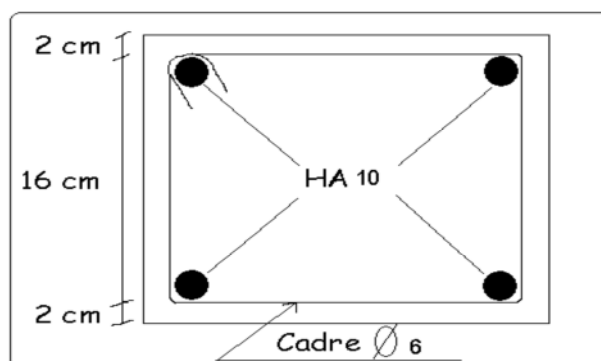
Schéma de ferrailage de la poutre de chaînage
